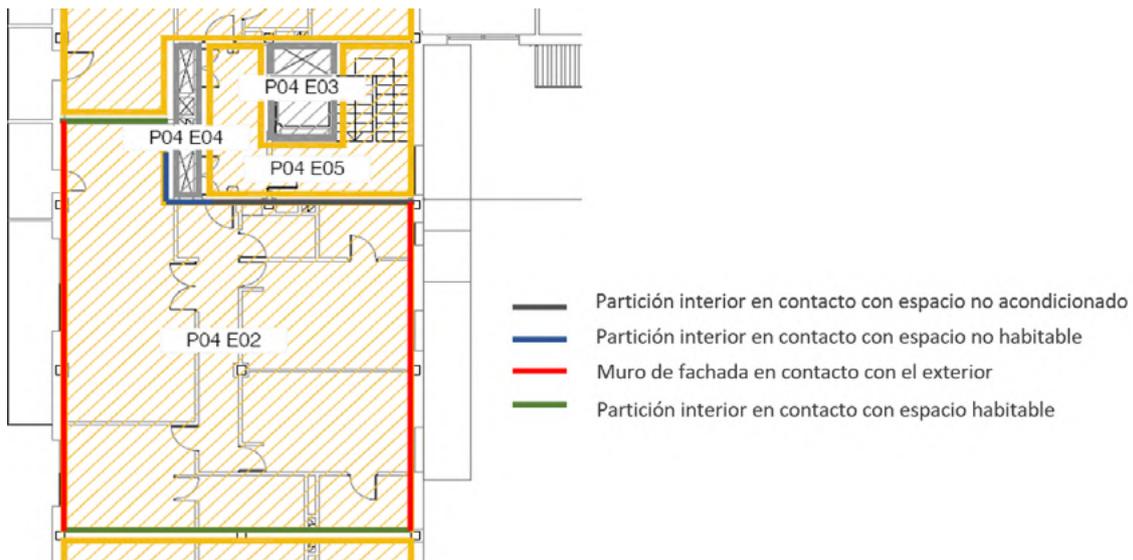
Plano planta de la vivienda objeto de estudio, mostrando los distintos cerramientos
